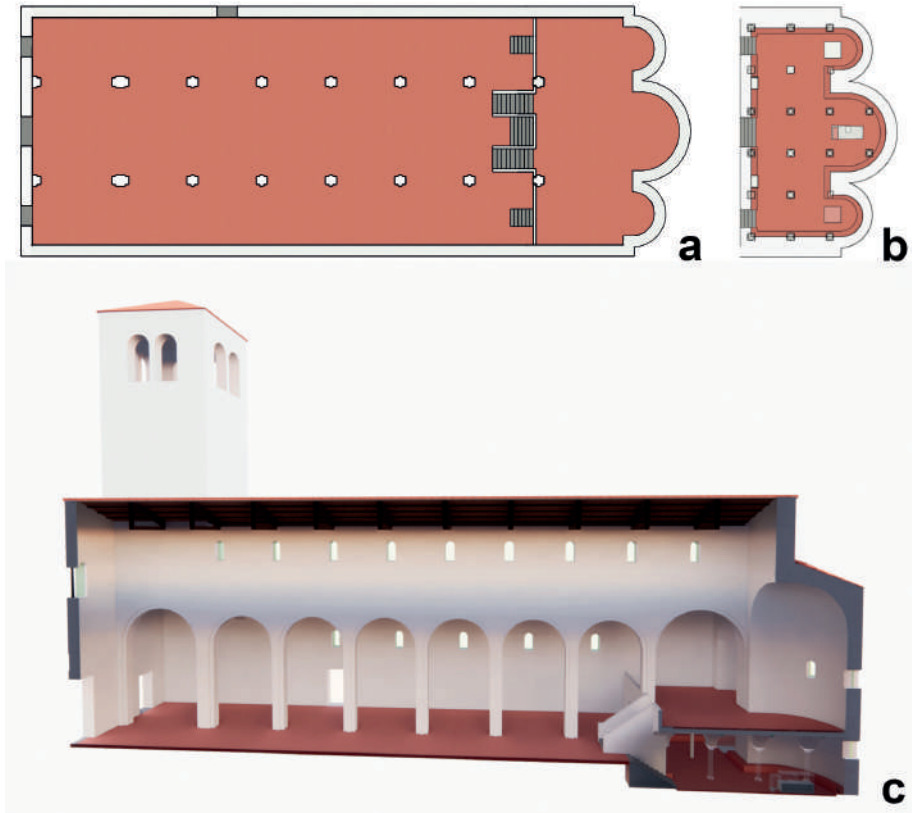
a) Spaccato planimetrico in proiezione parallela della ricostruzione tridimensionale. b) Spaccato planimetrico in proiezione parallela della ricostruzione tridimensionale, particolare dell'ambiente della cripta. c) Spaccato prospettico laterale della ricostruzione tridimensionale.
